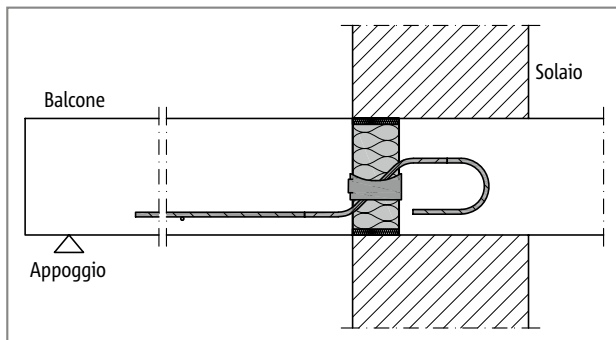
Schöck Isokorb® T tipo QL: balcone con appoggio su muratura monostrato
